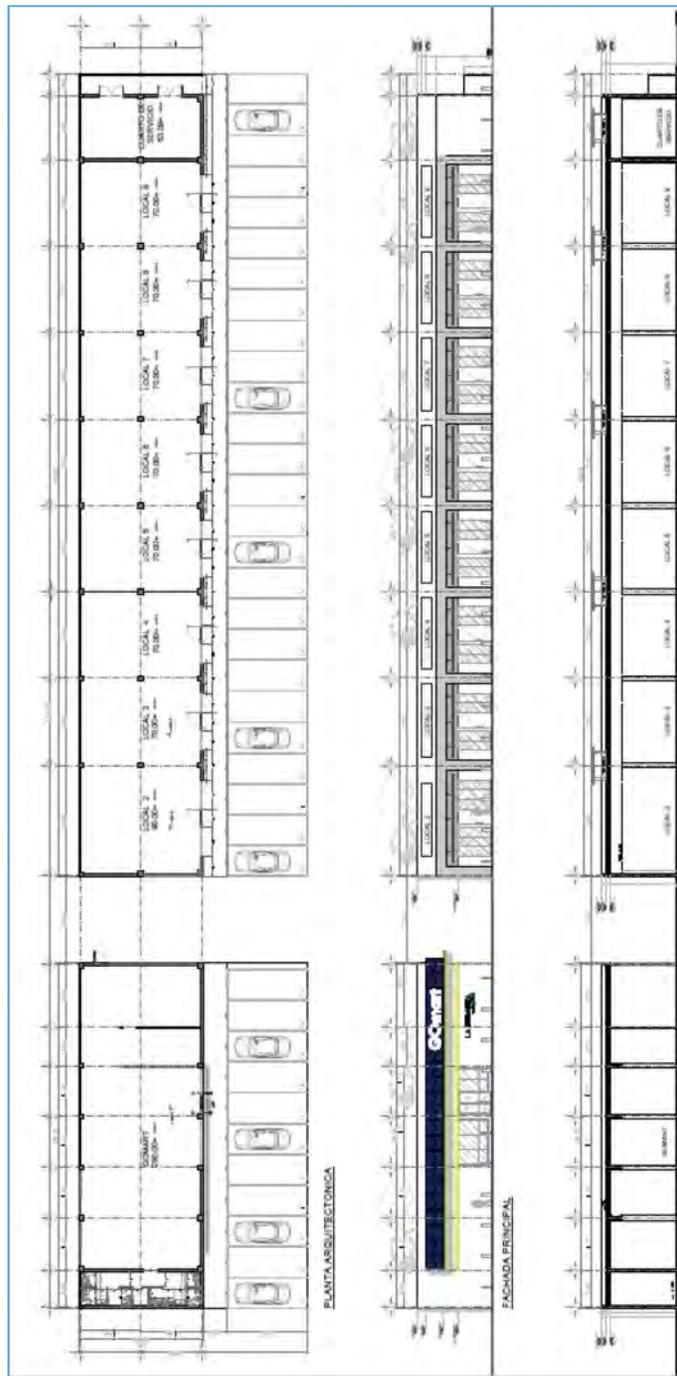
Figura del plano de conjunto y fachadas del proyecto.
